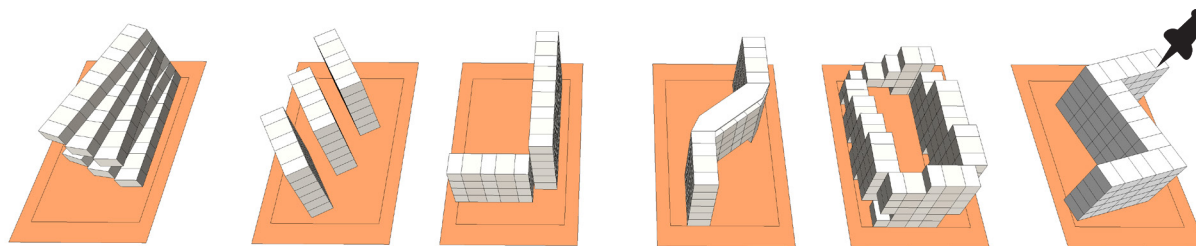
Estudo de disposição dos alojamentos sobre o terreno, visando máximo aproveitamento e condicionantes climáticos.
